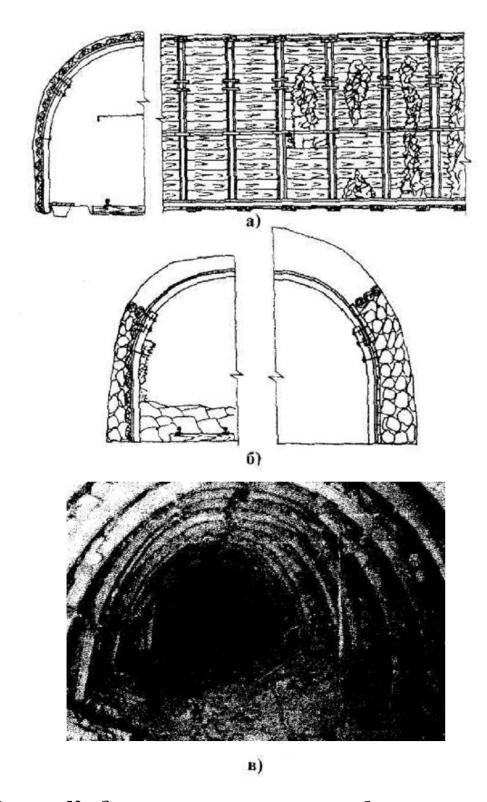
Замена затяжек: а – деревянных без изменения их типоразмеров; б – деревянных на железобетонные; в – распилов на круглые стойки
